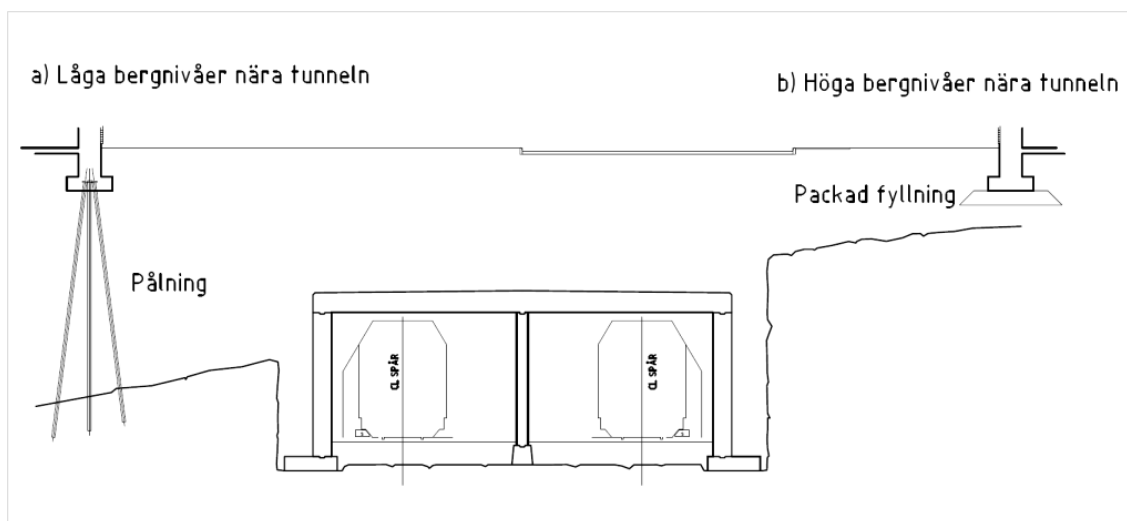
Principskiss visande möjlig grundläggningsmetod vid låga bergnivåer nära tunneln (fall a) och höga bergnivåer nära tunneln (fall b). I fall b påverkas inte tunneln av last från grundkonstruktionen. Det går också att schakta fram tunneln utan att äventyra stabiliteten för byggnaden. I fall a erfordras pålning både för att last inte ska påföras tunnelväggen samt för att byggnaden ska vara stabil om tunneln måste friläggas.
